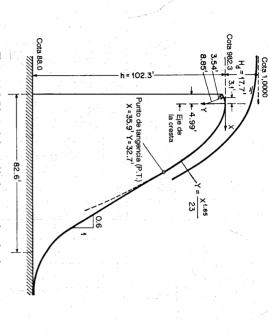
Diseño de la sección de un vertedero de rebose.
